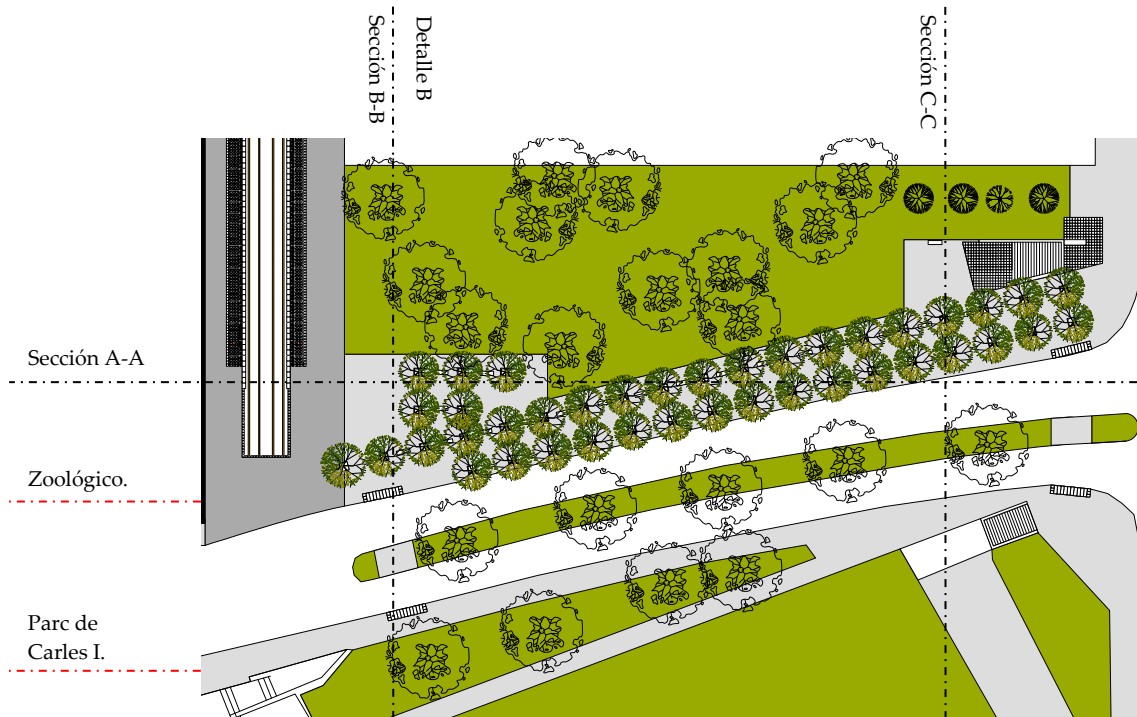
Planta intercambiador. Fuente: elaboración propia.
